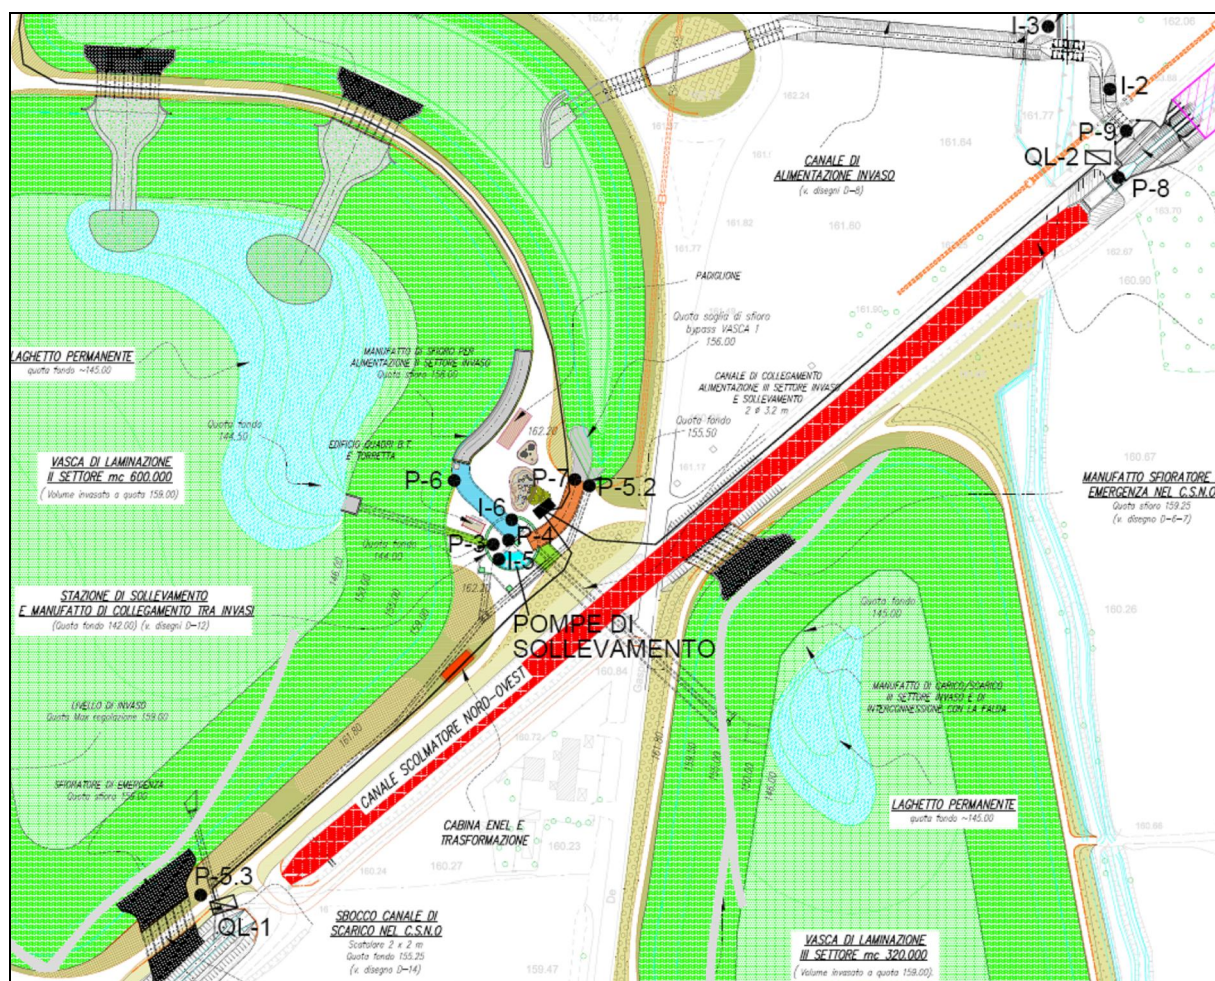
Stralcio planimetrico con l'ubicazione delle paratoie "P".
